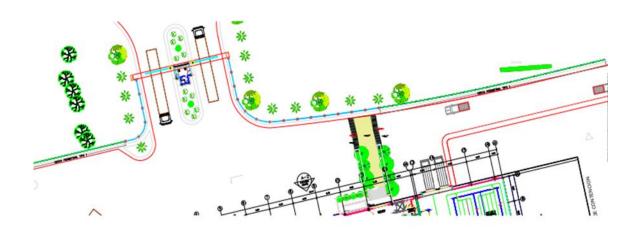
Plano arquitectónico de los corrales del proyecto.
